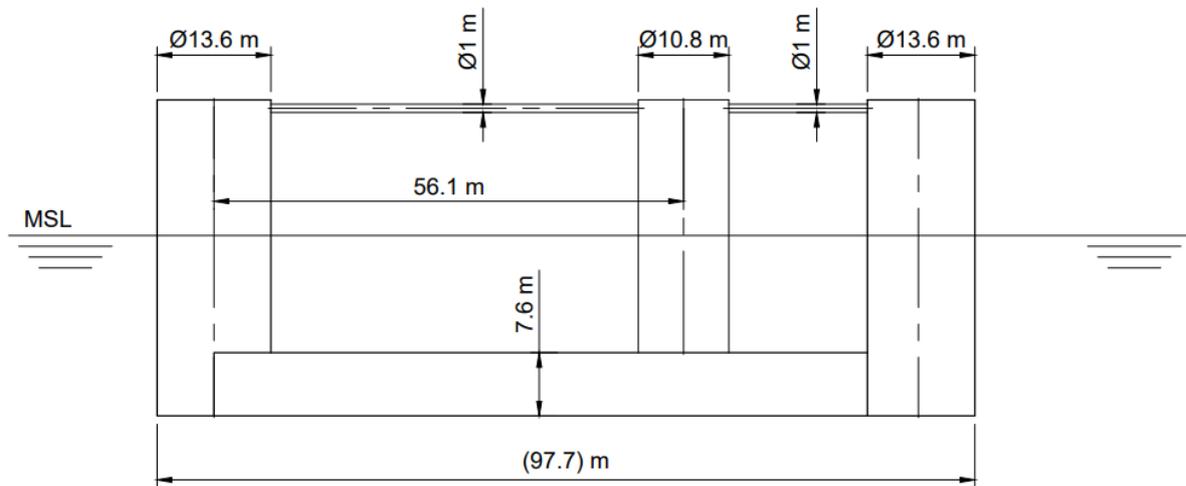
Prospetto della fondazione galleggiante (fonte: Tavola OW.ITA-SAR-GEN-OWC-ENV-DWG-53B).
